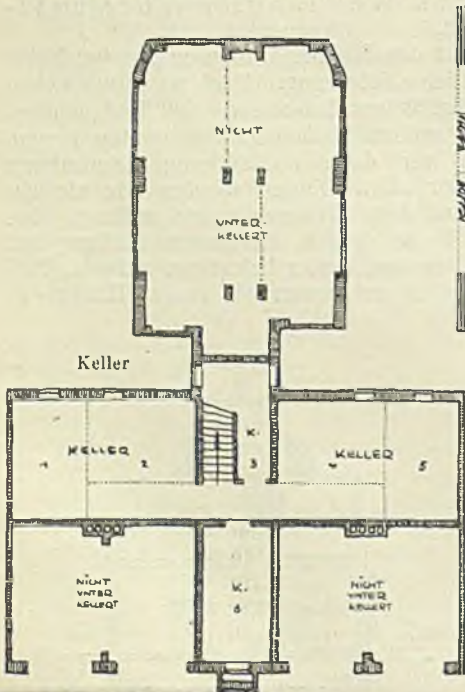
Sechsfamilienhaus. Architekt B.D.A. Stoffregen in Bremen. (Diese Grundrisse und der Lageplan gelten auch für das Massenmiethaus)
